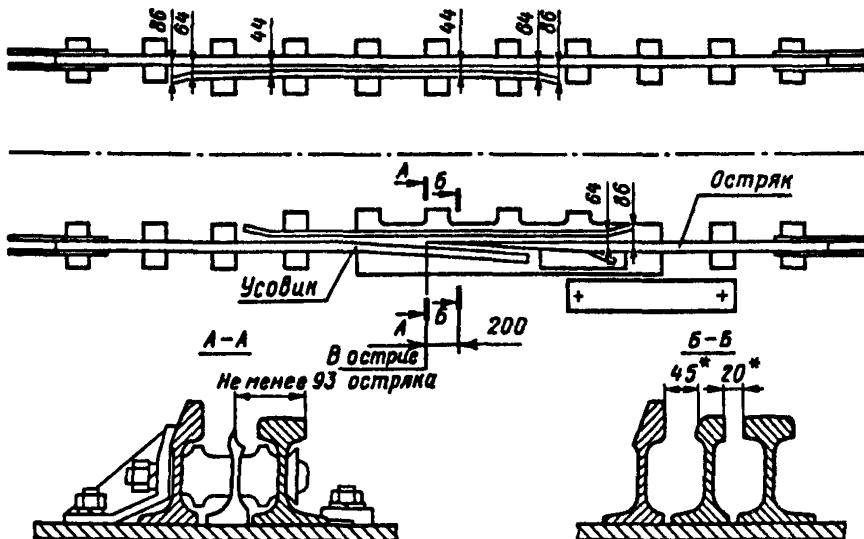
Башмакосбрасыватели типов Р50, Р65 колен 1520 мм:
